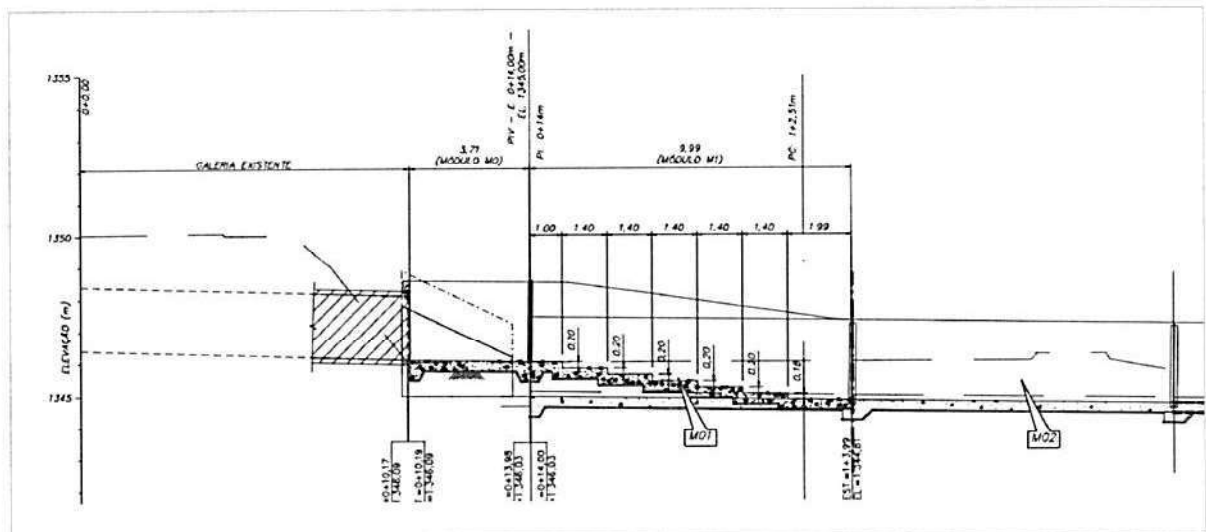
Detalhamento da transição entre o bueiro existente e o canal complementar (Fonte: Doc. [20]).
